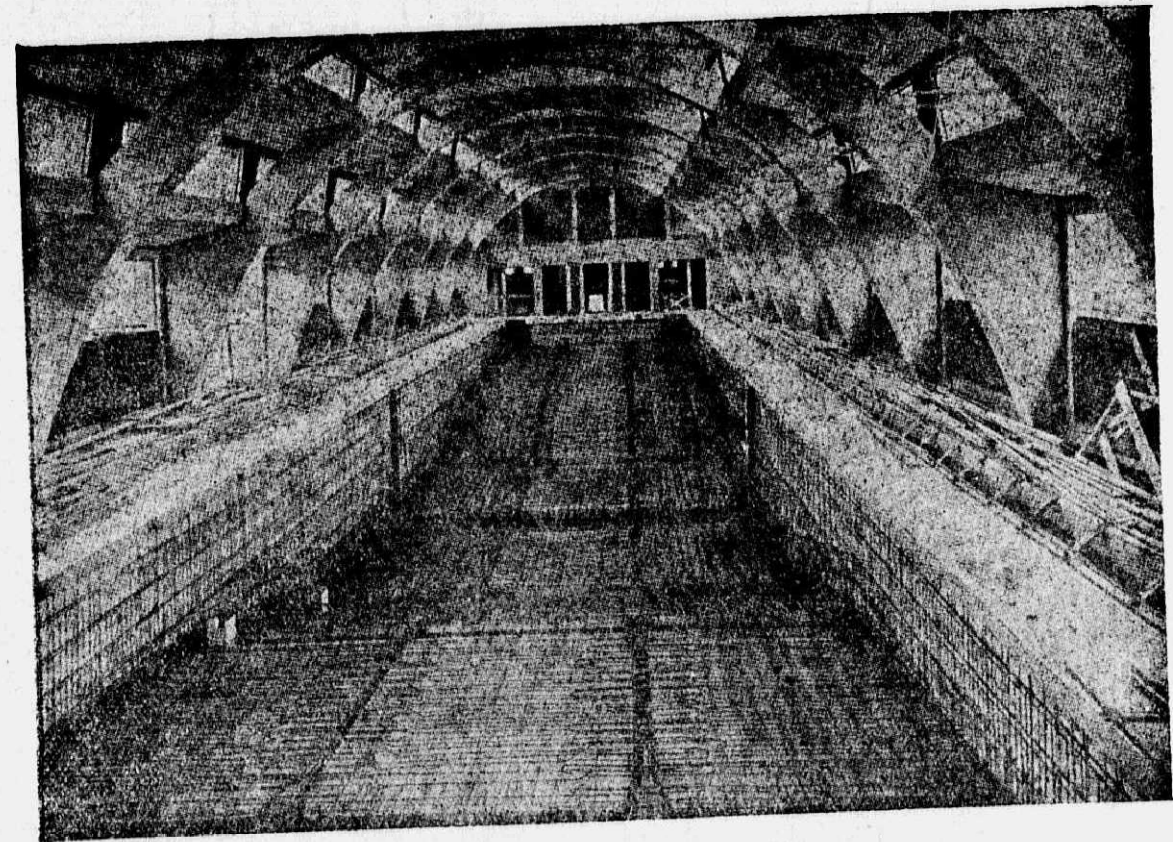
Свайный фундамент под плават. бассейном в Штуттгарте.
